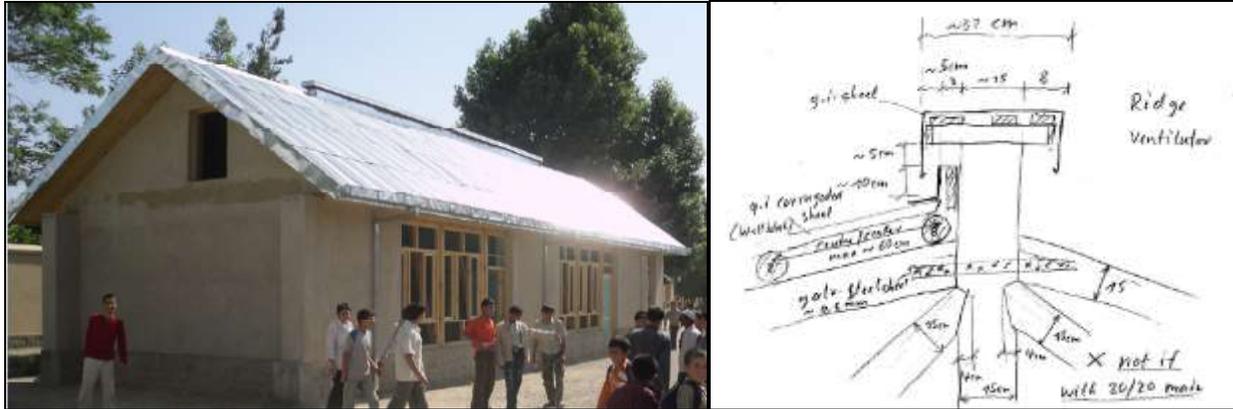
Système de toiture ventilée avec bouche de sortie en point haut appliqué dans une école en Afghanistan, GIZ, 2010
